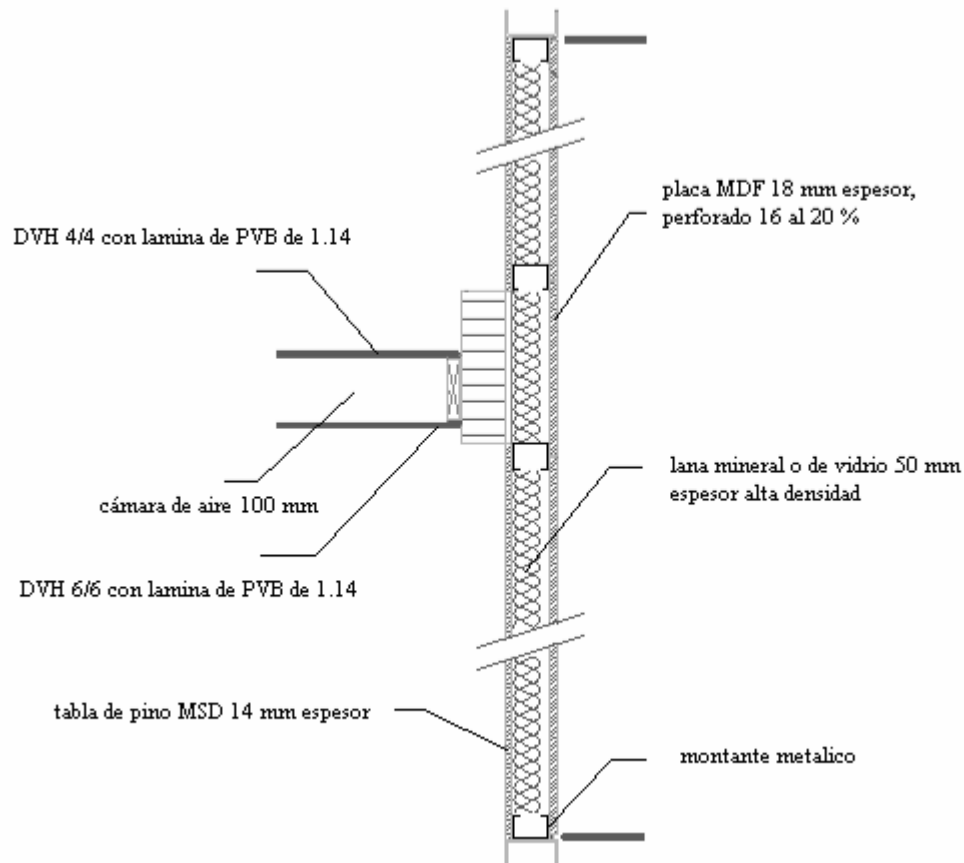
Modificación puerta doble y muro vidriado salón.
